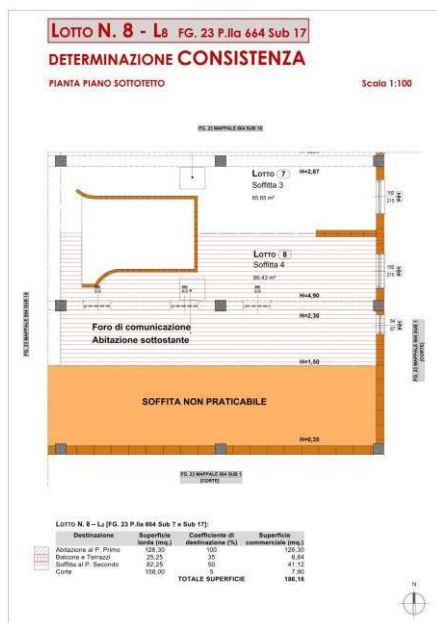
Determinazione consistenza Lotto L8 (ALL. 11).
